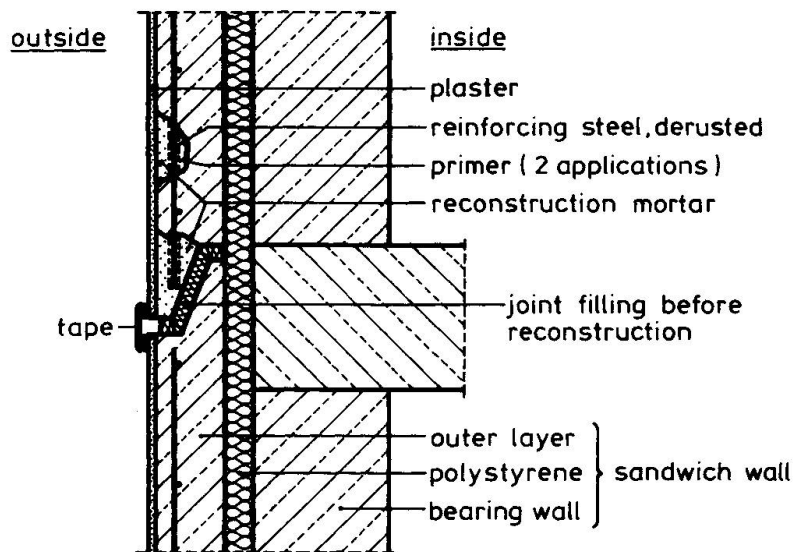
Konventionelle Instandsetzung geschädigter Betonoberflächen
